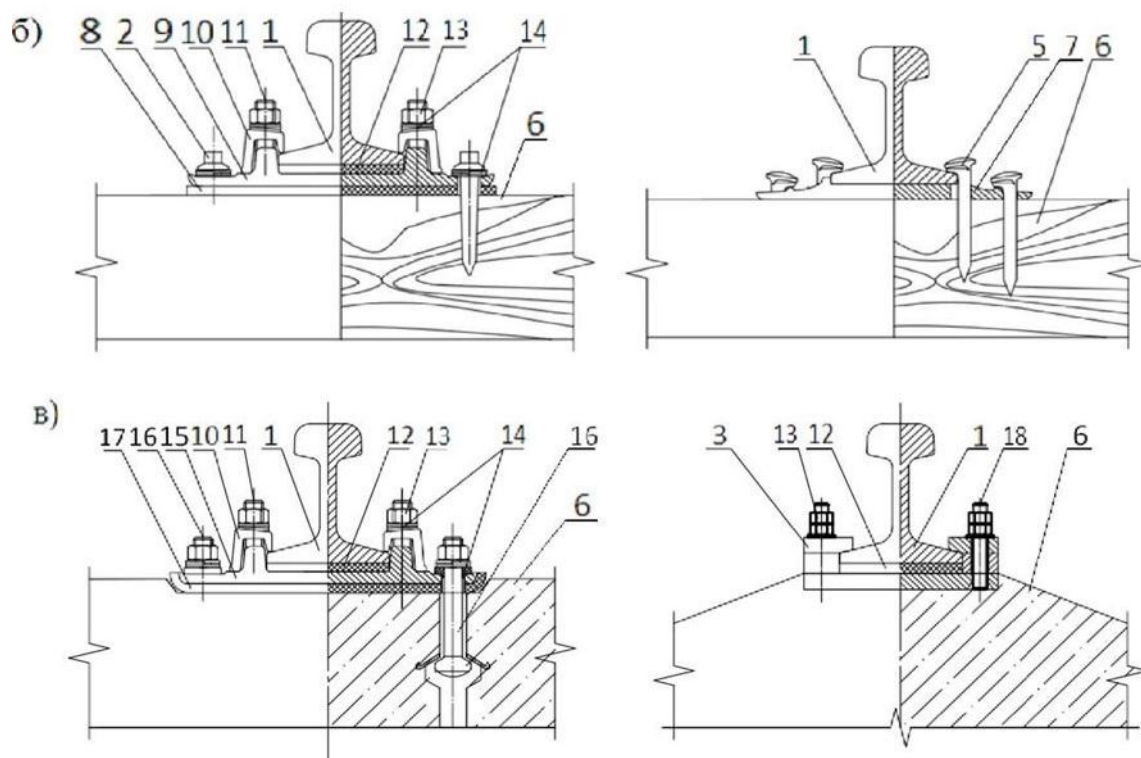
Промежуточные крепления направляющих на деревянных и железобетонных опорных элементах
